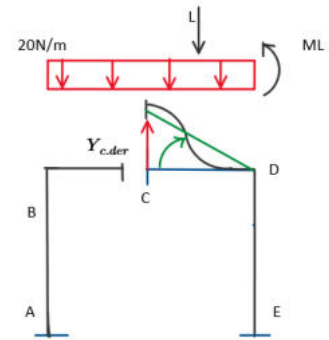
Trabajo virtual aplicado al desplazamiento vertical.
